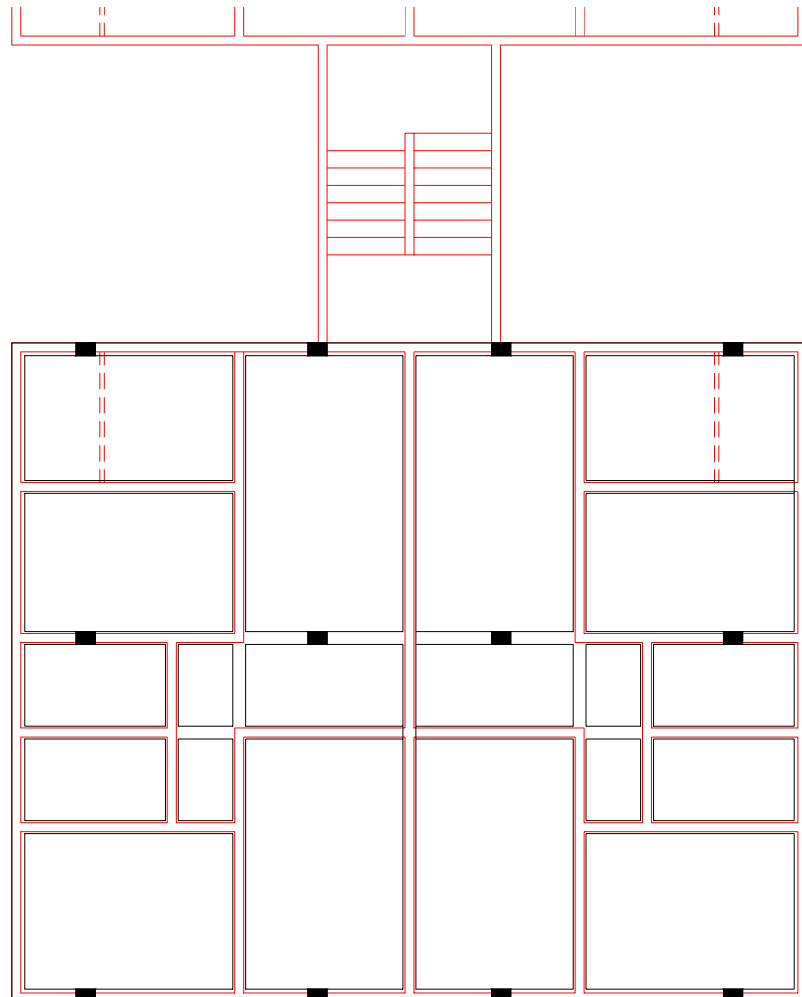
Prédio “C” – Opção 1 – Superposição das alvenarias do pavimento tipo sobre a estrutura
